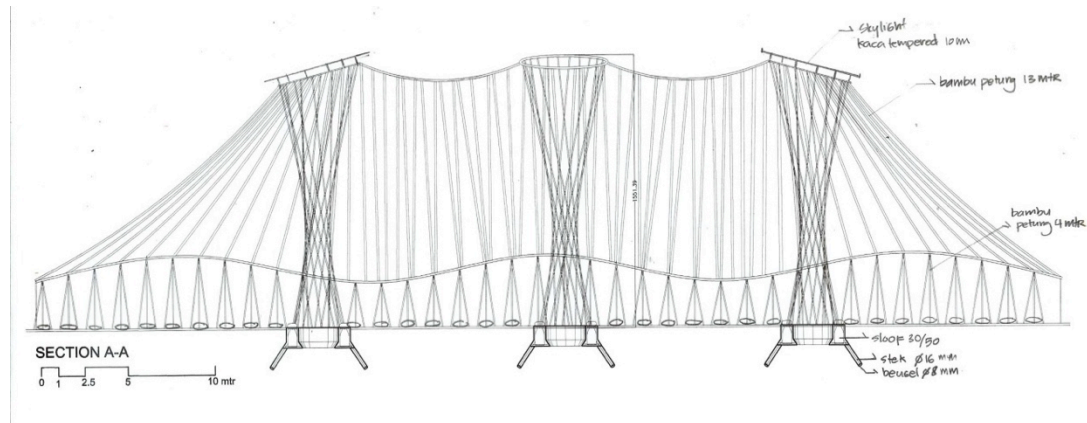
Secção longitudinal – “Three mountains Lodge” – Jorg Stamm, Bali, 2007
